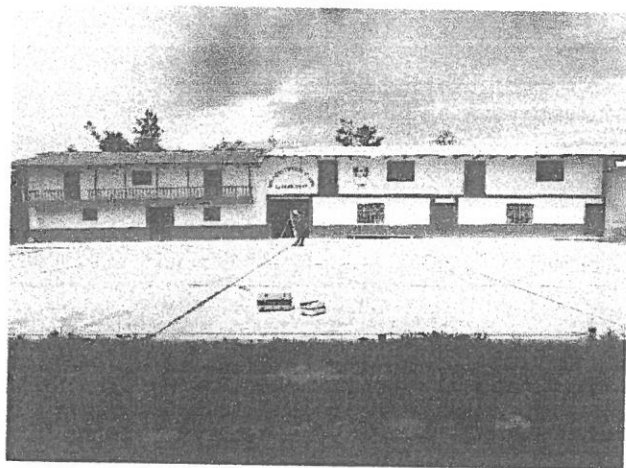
Módulo aulas de material rústico con estructuras y techos en mal estado.
